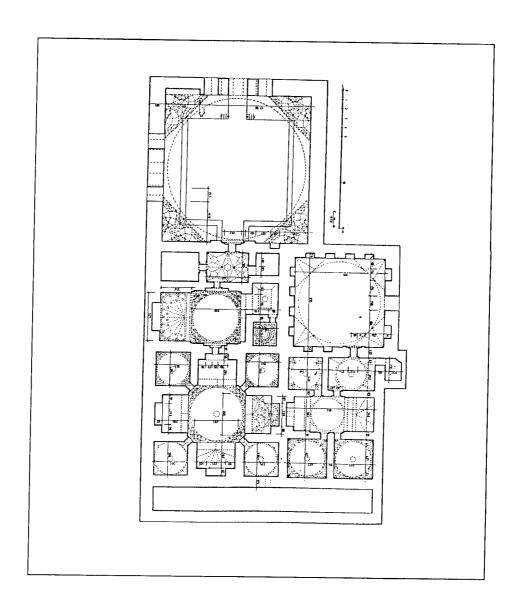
مسقط أفقي لعمارت ميخال أوغلو محمد بك في اهتمان ببلغاريا (عن : كيل) .
